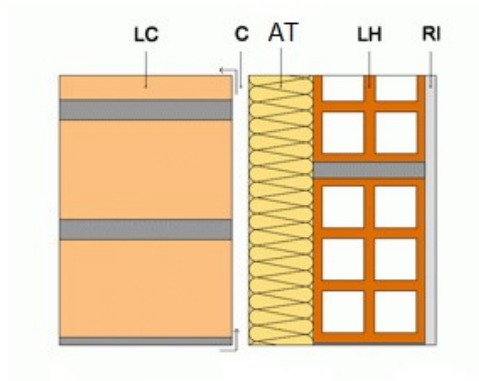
Fachada vista, ventilada, con aislamiento por el interior.
